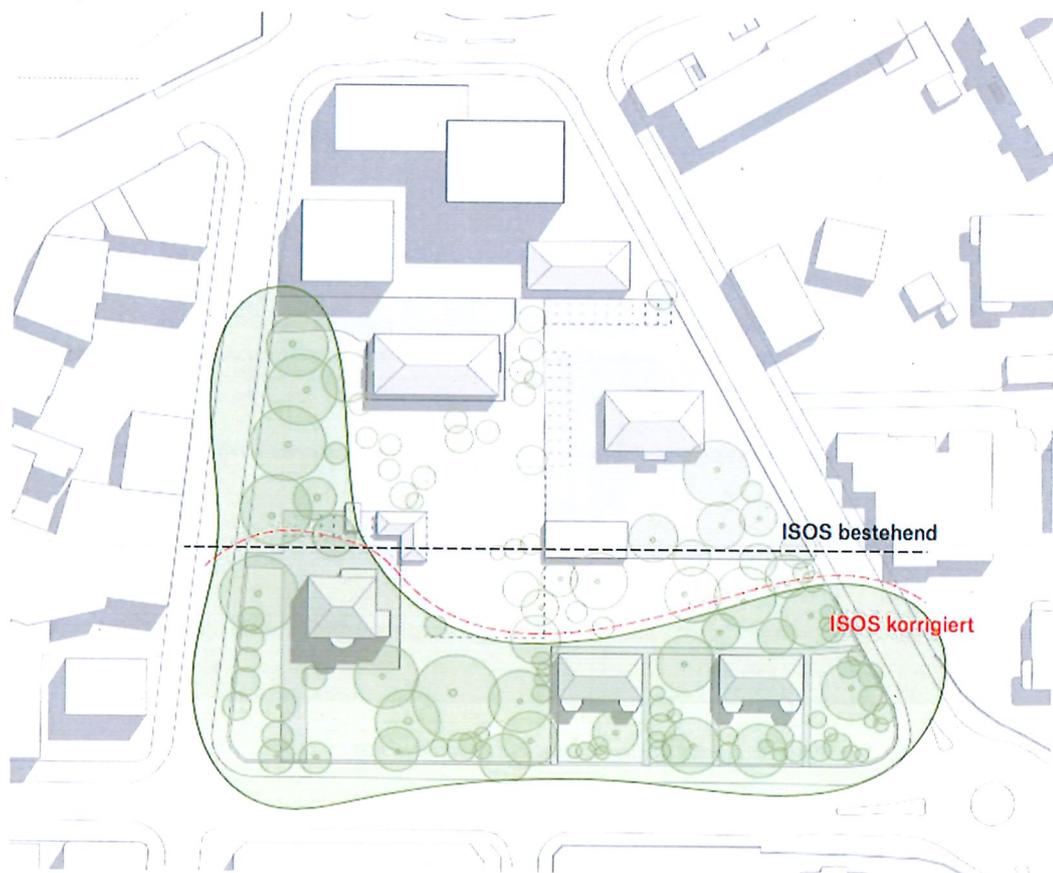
Situationsplan Richtprojekt (Quelle: SSA Architekten AG)
